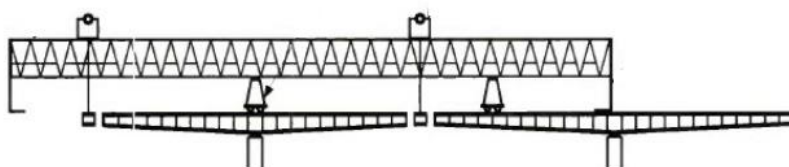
| 31 – Corte longitudinal de uma viga de lançamento [10]
